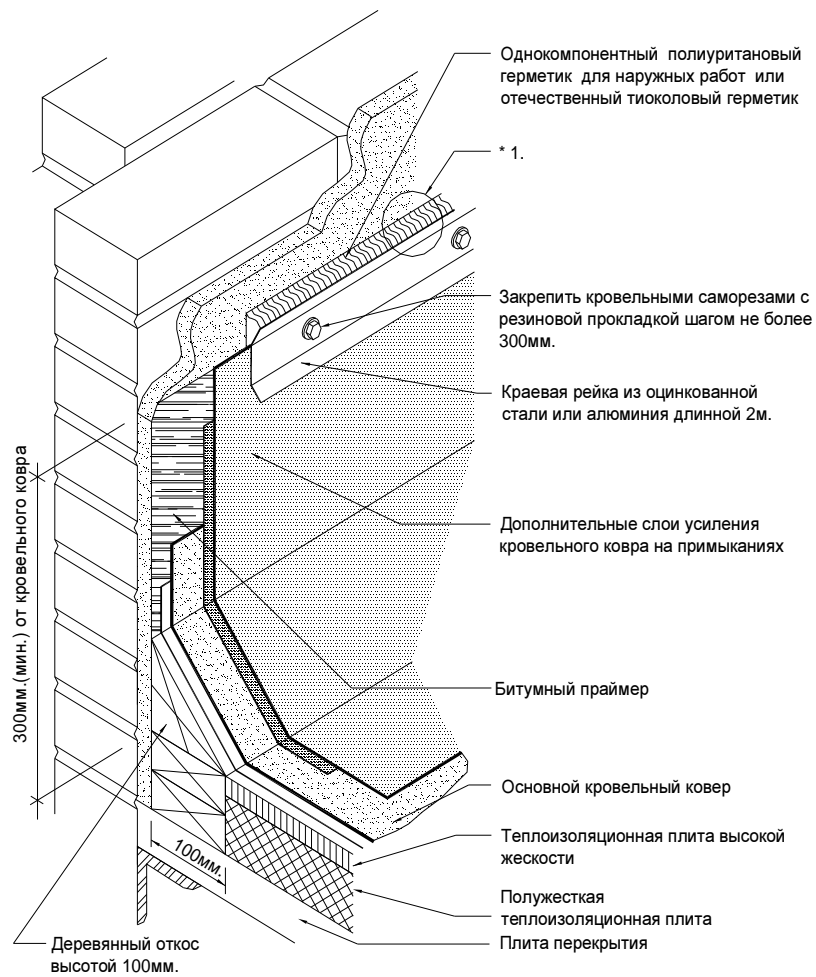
Примыкание кровли к оштукатуренной парапетной стене.
